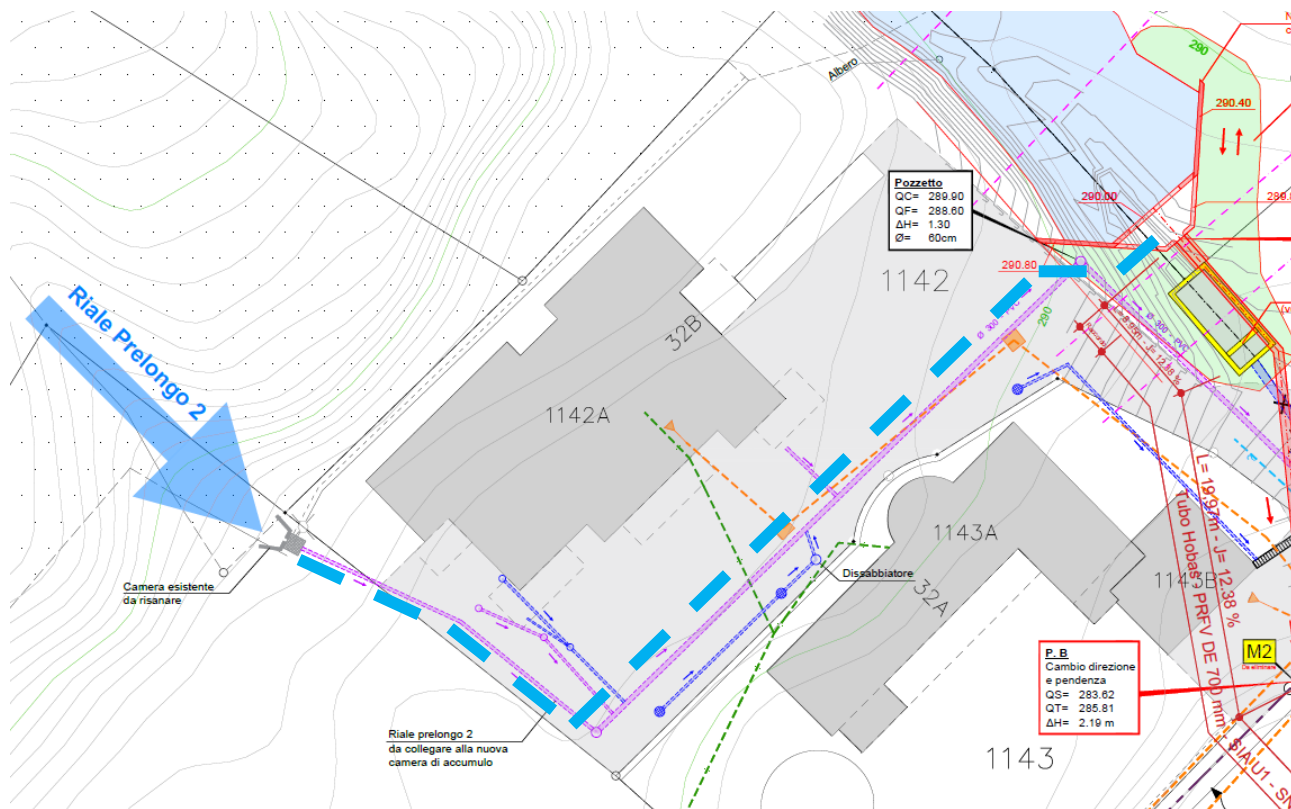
Estratto planimetria con schema canalizzazione da prevedere per riale Prelongo 2
